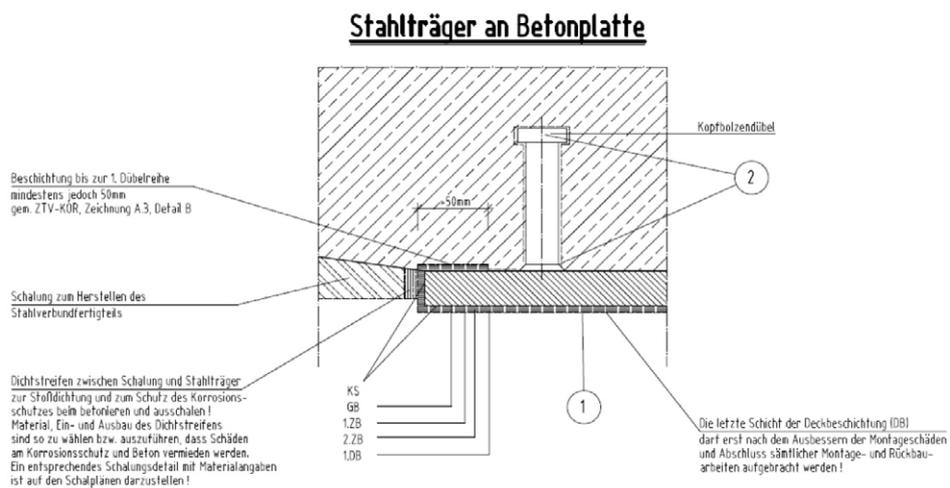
„Ausbildung der Schnittstelle zum Beton“
